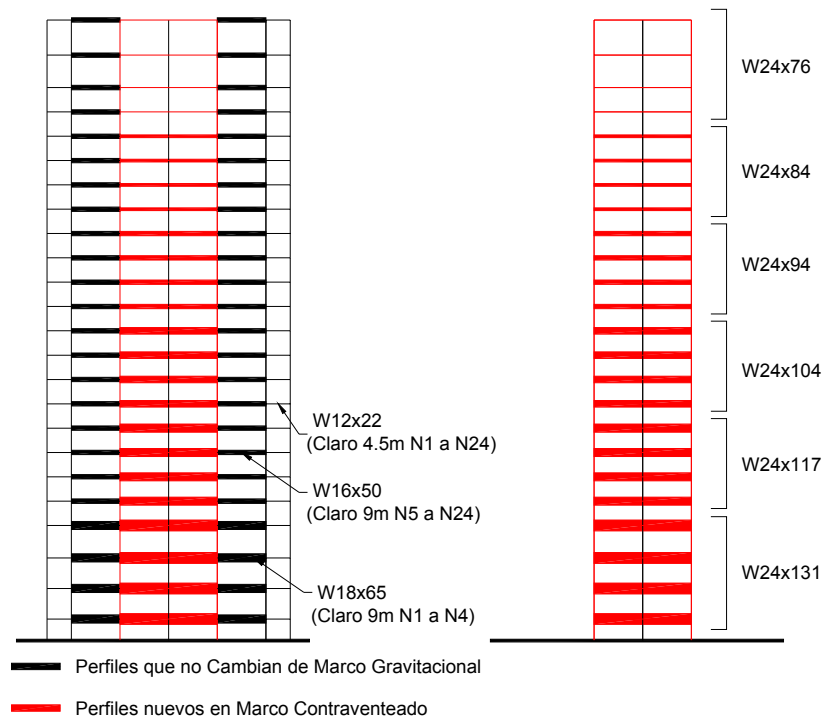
Perfiles de Vigas en Marco Contraventeado
